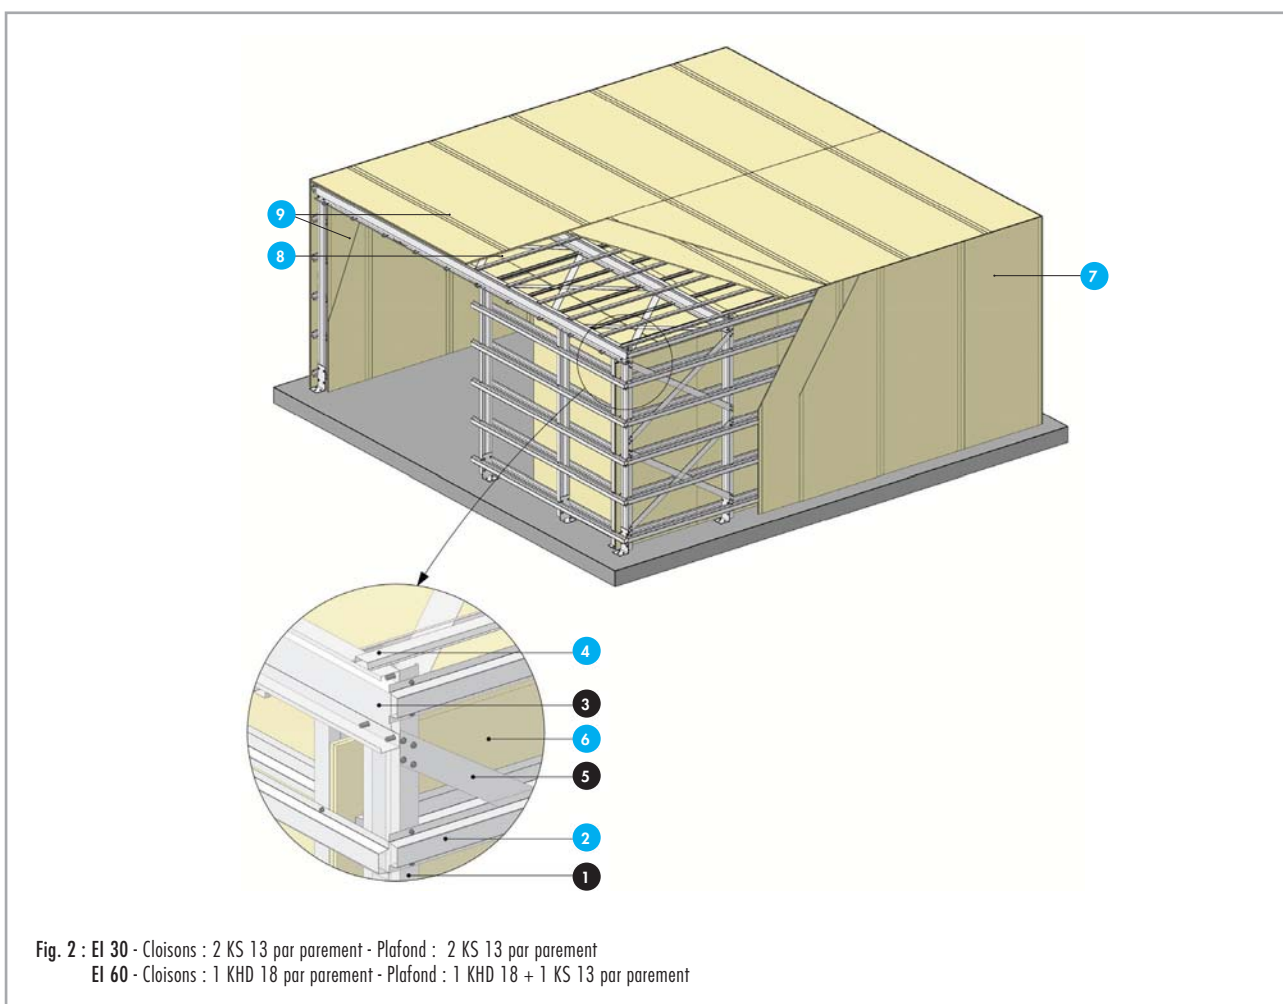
EI 30 - Cloisons : 2 KS 13 par parement - Plafond : 2 KS 13 par parement
